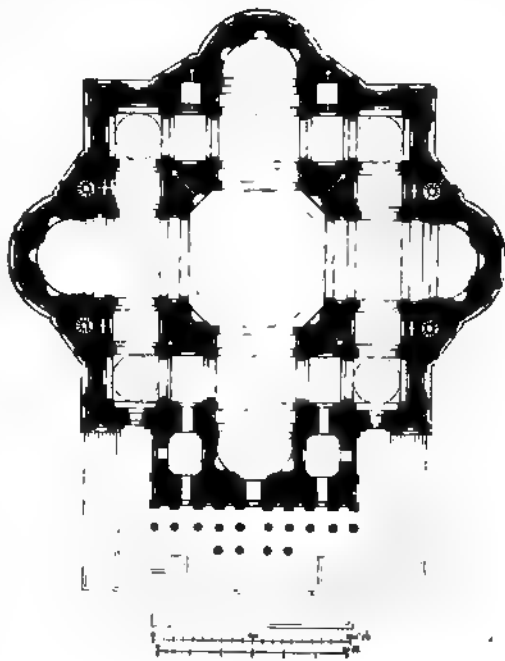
Grundriss von St. Peter (Michelangelo)
